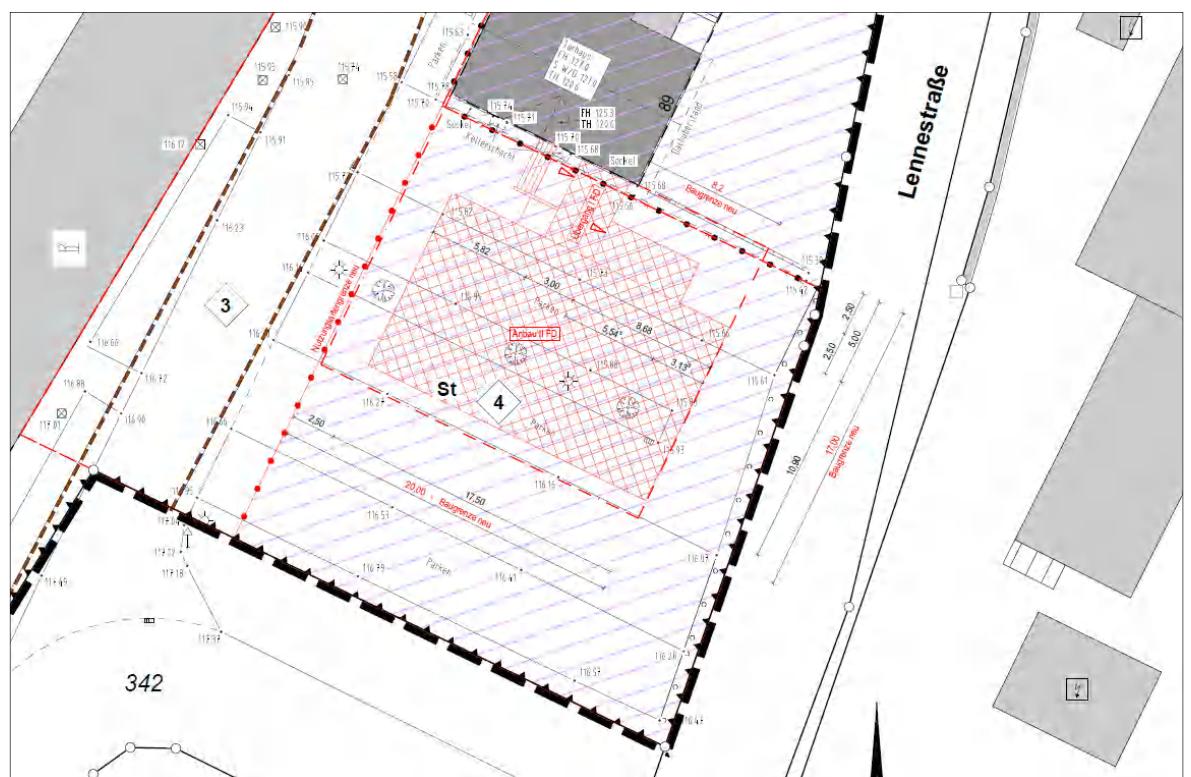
Auszug aus dem Amtlichen Lageplan mit Darstellung des Plangebietes und der Baugrenzen [9]
